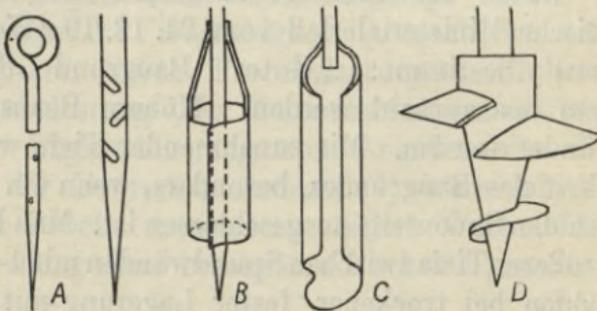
Bohrgeräte. A = Sondiereisen. B = Zylinderbohrer. C = Löffelbohrer. D = Schraubenbohrer.
